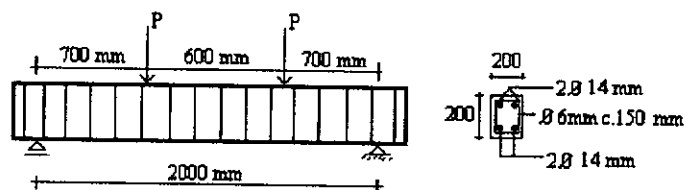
Armaduras de reforço de cada grupo de vigas.
